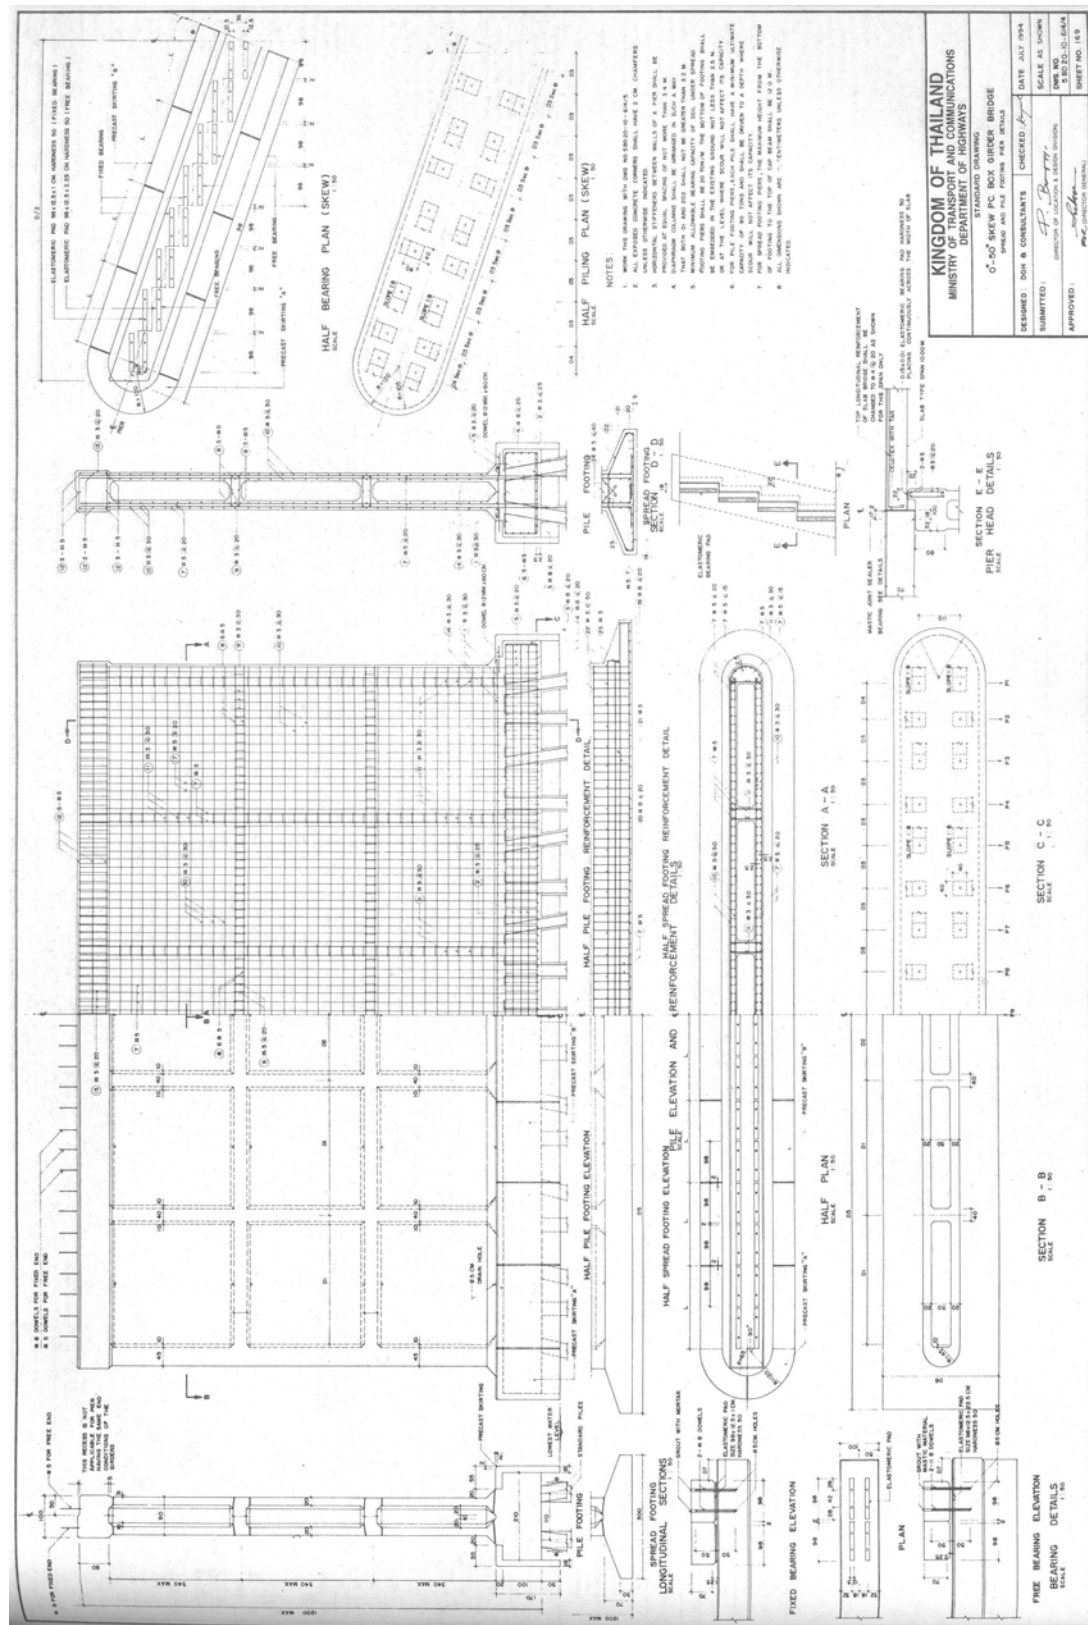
แบบมาตรฐานสะพานช่วงสั้น Plank Girder
